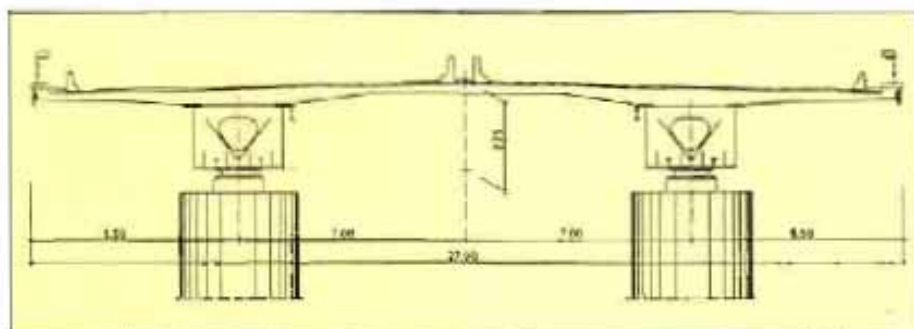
Sección transversal. Viaducto "Eau Rouge".
